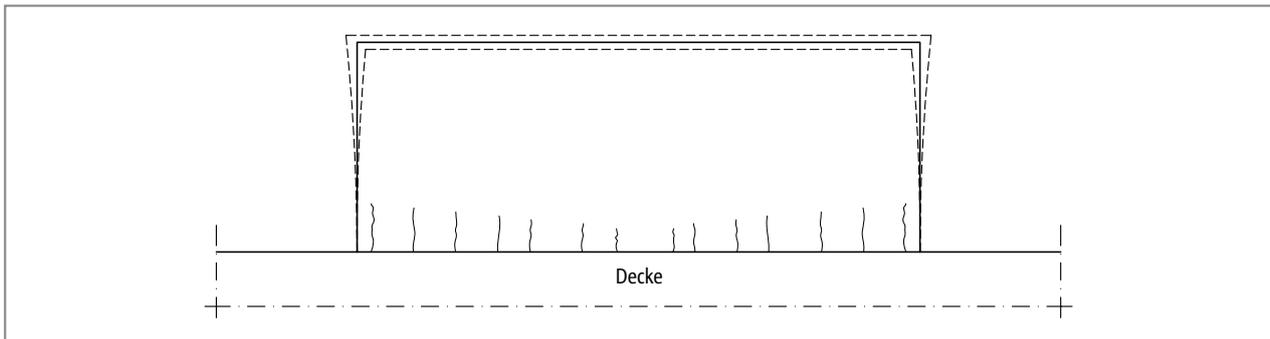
Balkonplatte ohne Schöck Isokorb®: Rissbildung durch Ermüdung möglich
